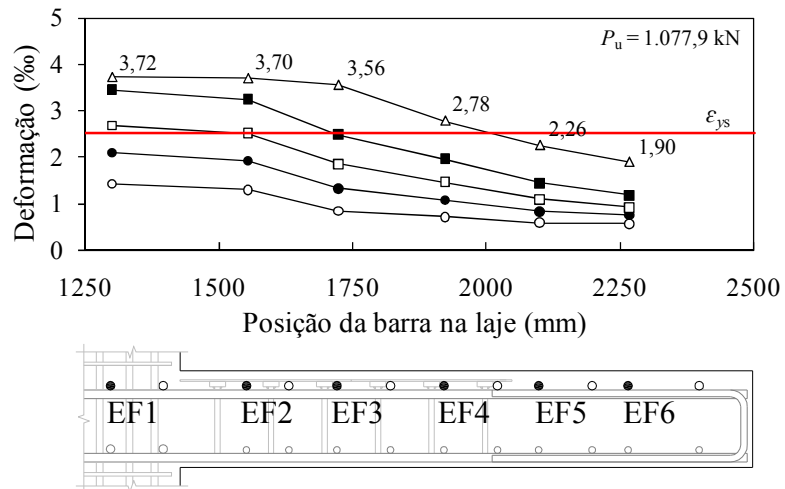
Deformações na armaduras de flexão da laje LC06
